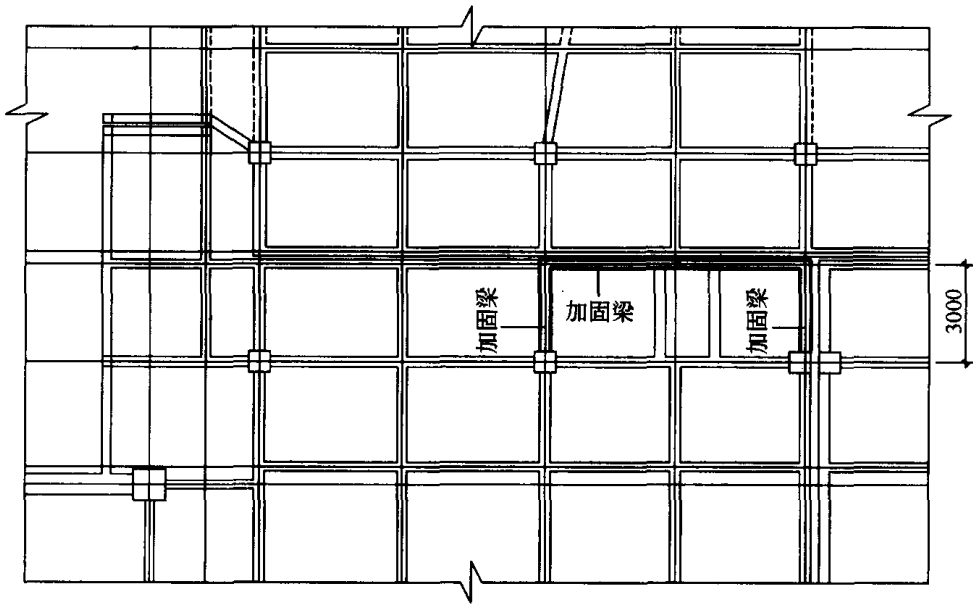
原结构局部平面布置图(加粗部分为加固梁)
